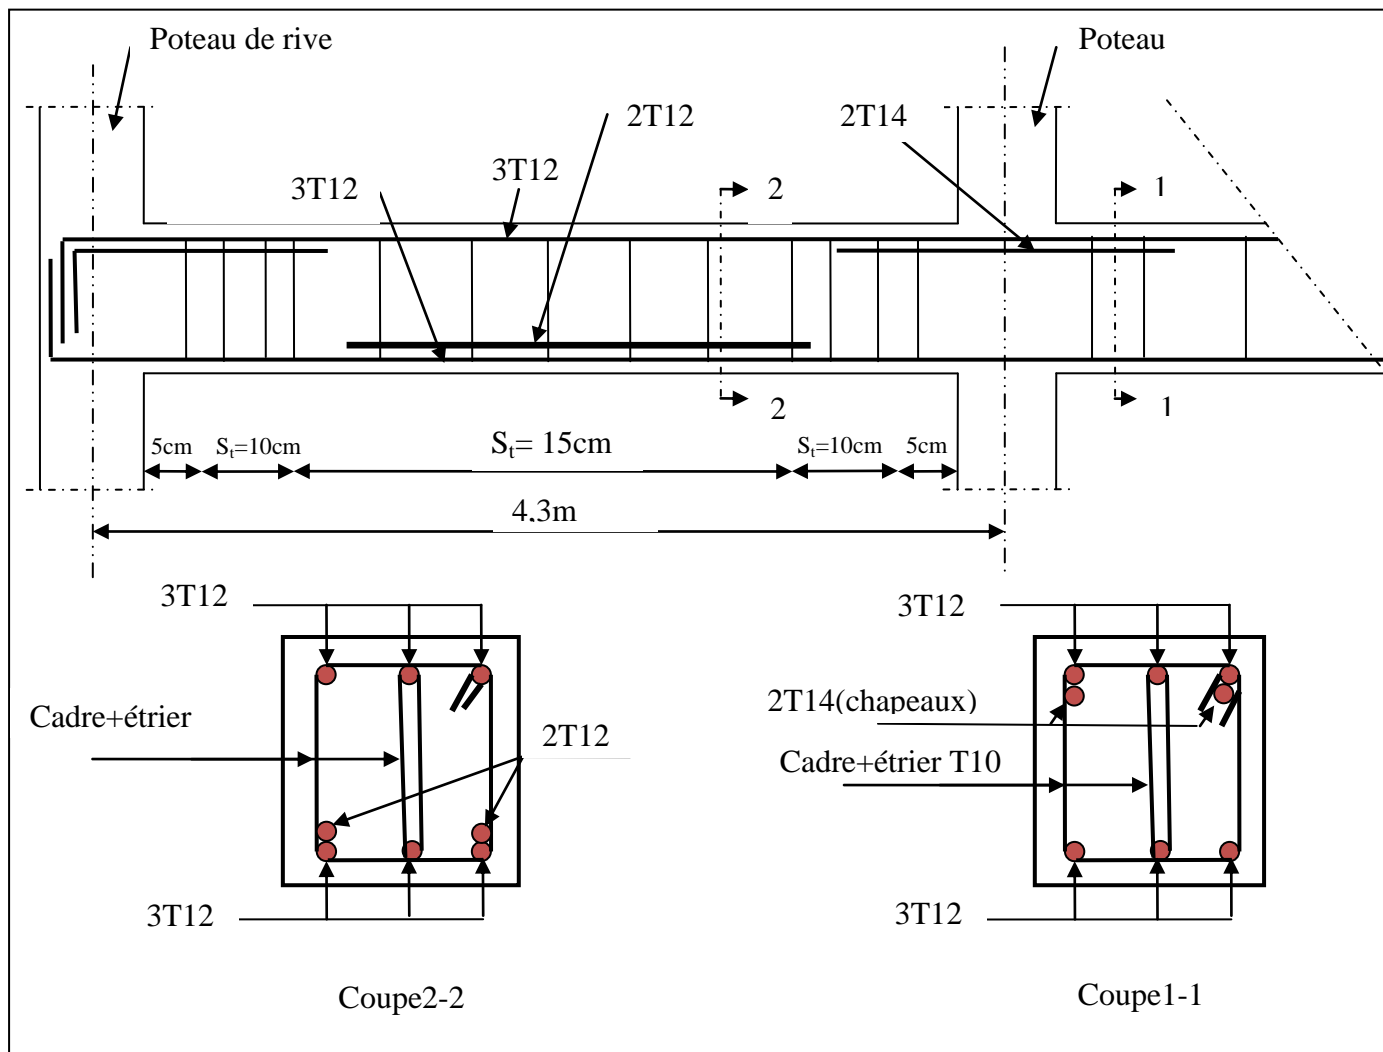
Schéma de ferrailage de la poutres secondaire du 1^{ère} étage.
